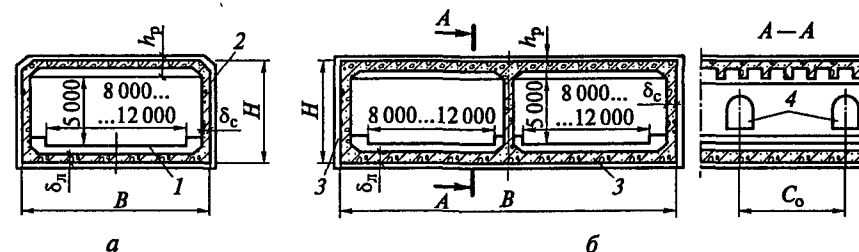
Конструкции (а, б) автотранспортных тоннелей из монолитного железобетона (при котлованном способе работ):
